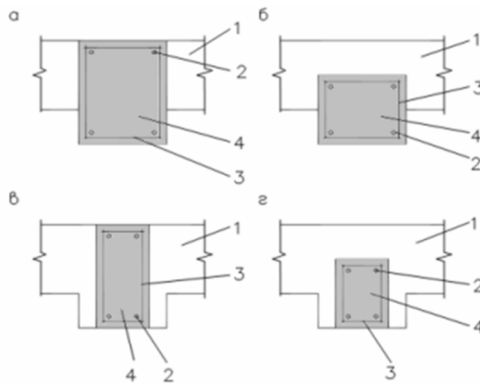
Посилення простінків з пілястрами монолітними залізобетонними елементами: а, в – наскрізне пробивання стіни, б, г – улаштування заглиблень з однієї сторони: 1 – кладка, що посилюється, 2 – поздовжня арматура, 3 – поперечна арматура, 4 – бетон посилення.
